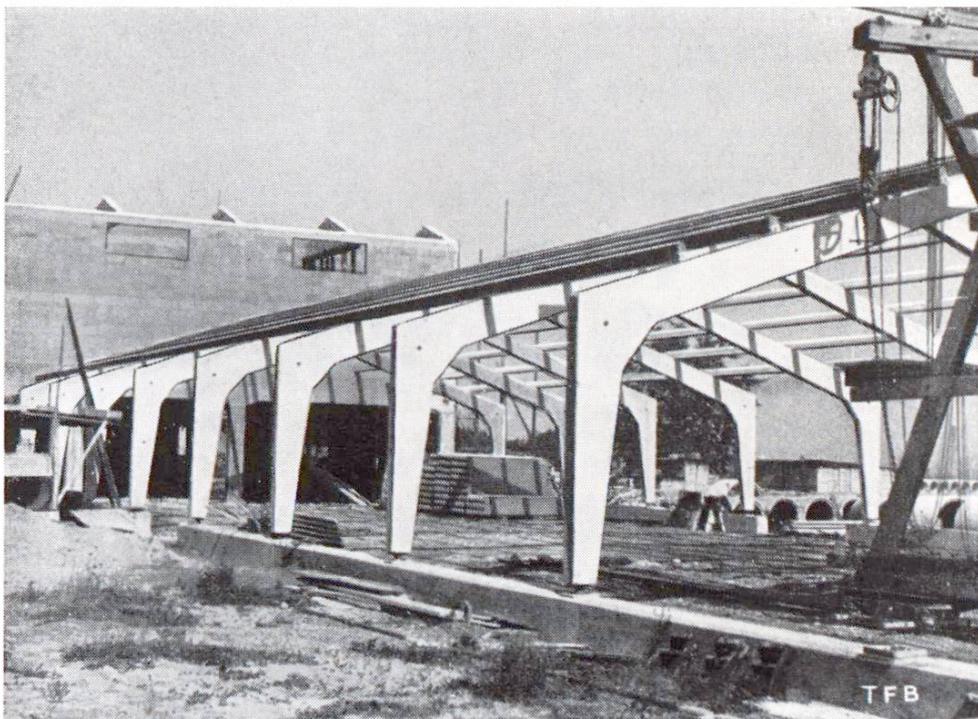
Seitenansicht der Konstruktion. Die Pfetten aus Eisenbeton sind im anschliessenden Gebäude verankert
